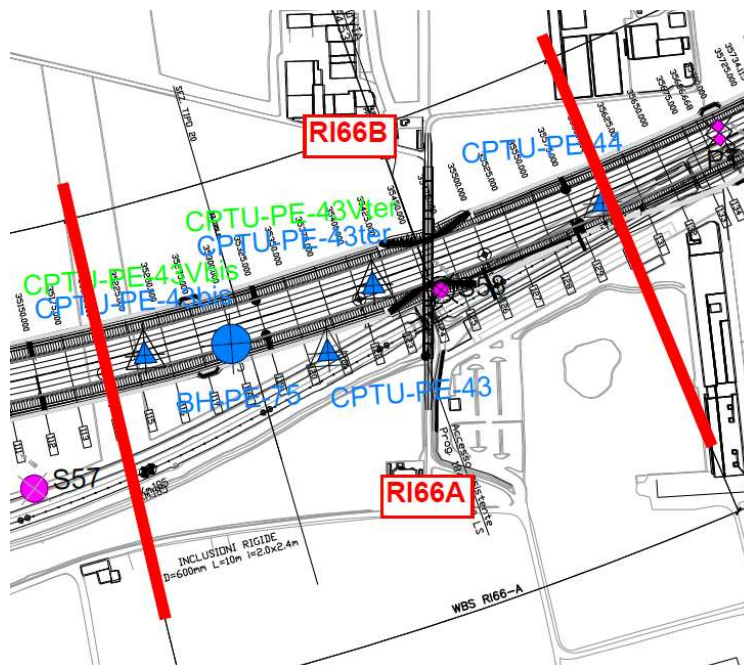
Planimetria Rilevato RI66A, estratto dalla Planimetria Generale (Doc. Rif. [7])
